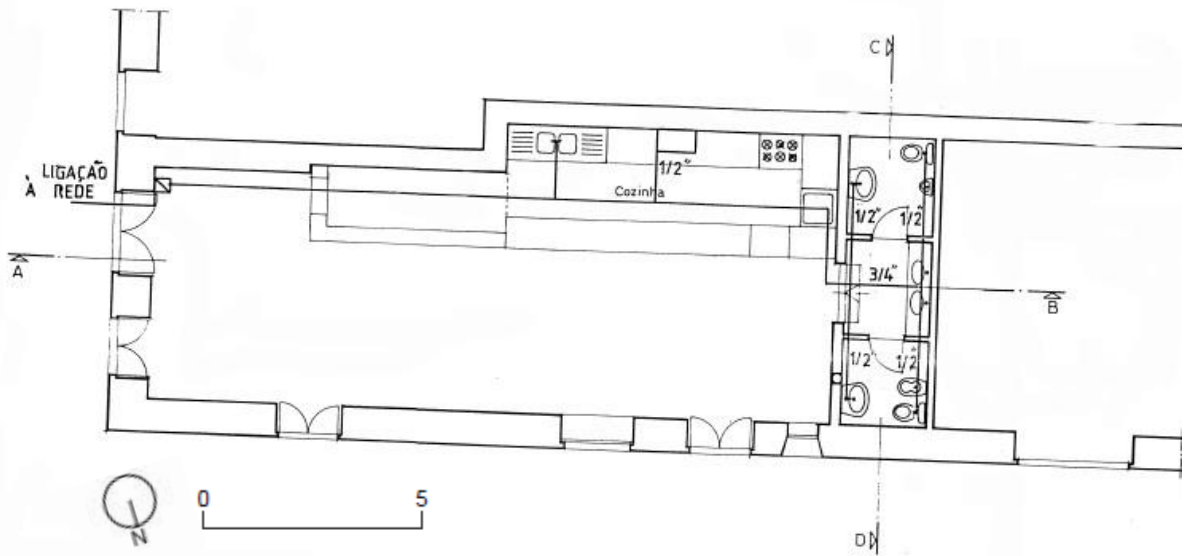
Planta da proposta - Esc. 1/200 – Autor do projeto
